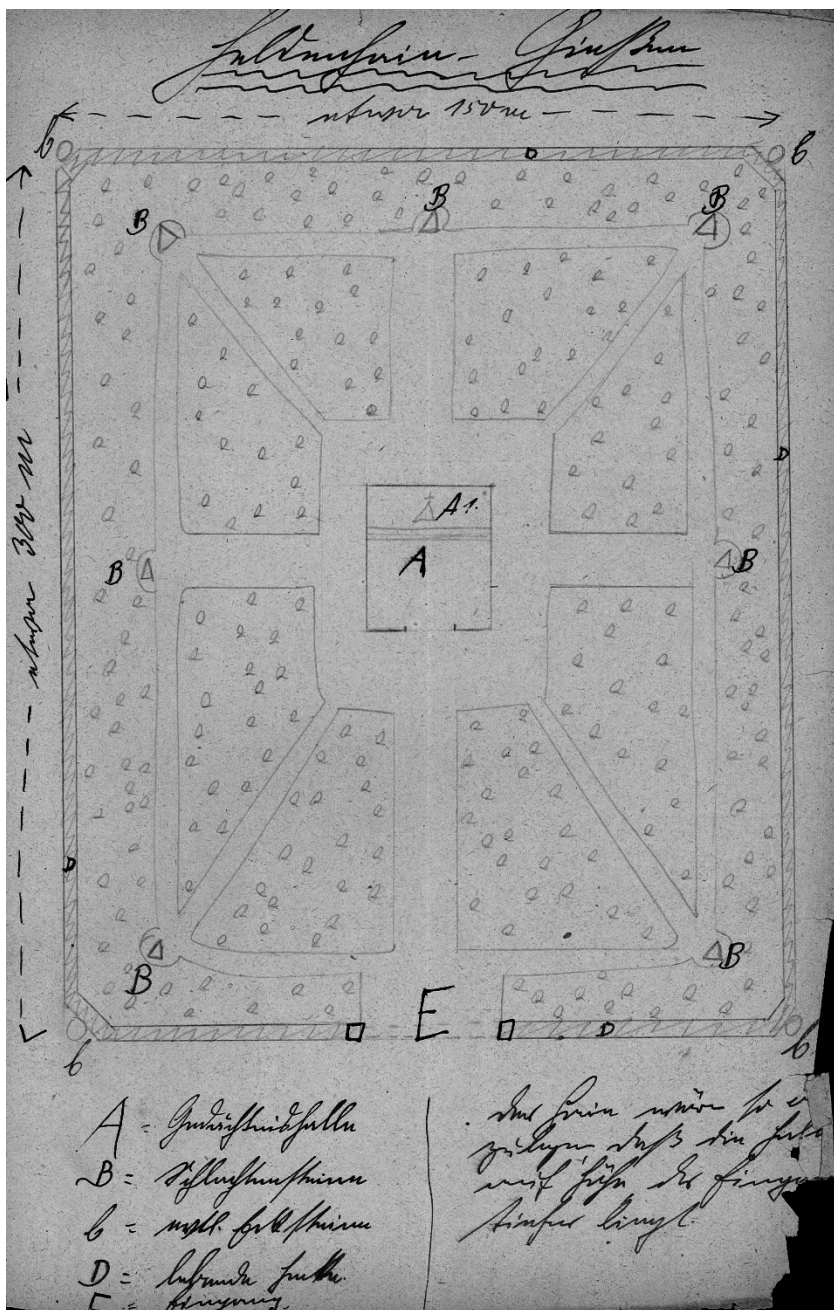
Plan zu einem Heldenbain (Stadtarchiv Gießen)
